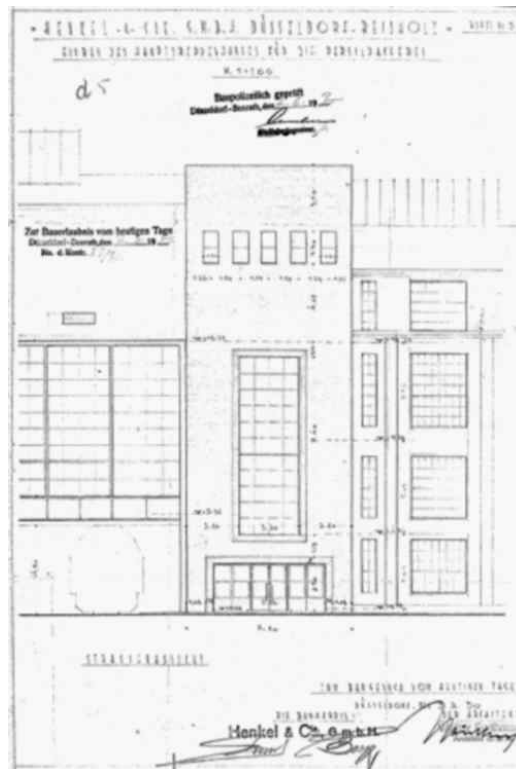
Neubau eines Treppenhauses zwischen Gebäude C04 und C 05, 1929 - Architekt: Walter Furthmann
